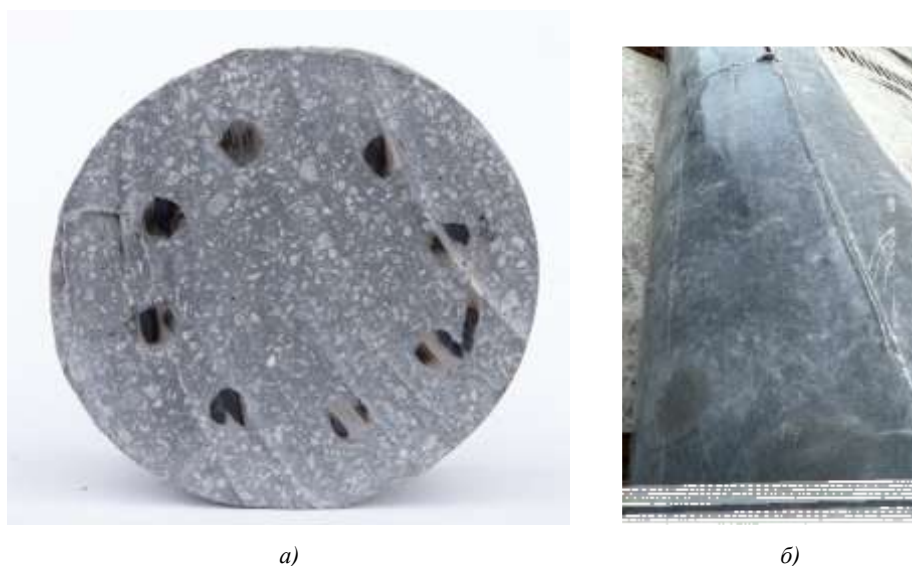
Качество уплотнения бетона: *а* — железобетонный сердечник в разрезе; *б* — боковая поверхность железобетонного ядра
